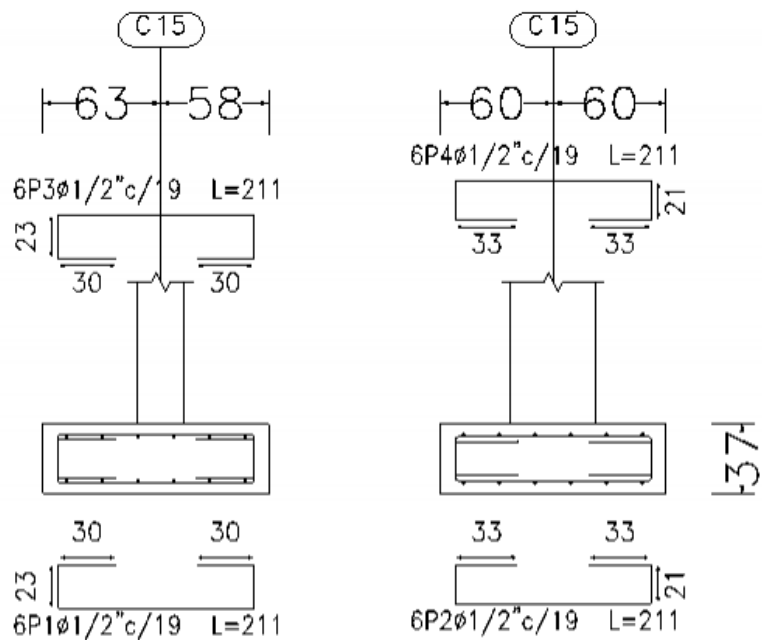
Detalle estructural de zapata con doble refuerzo C15.
